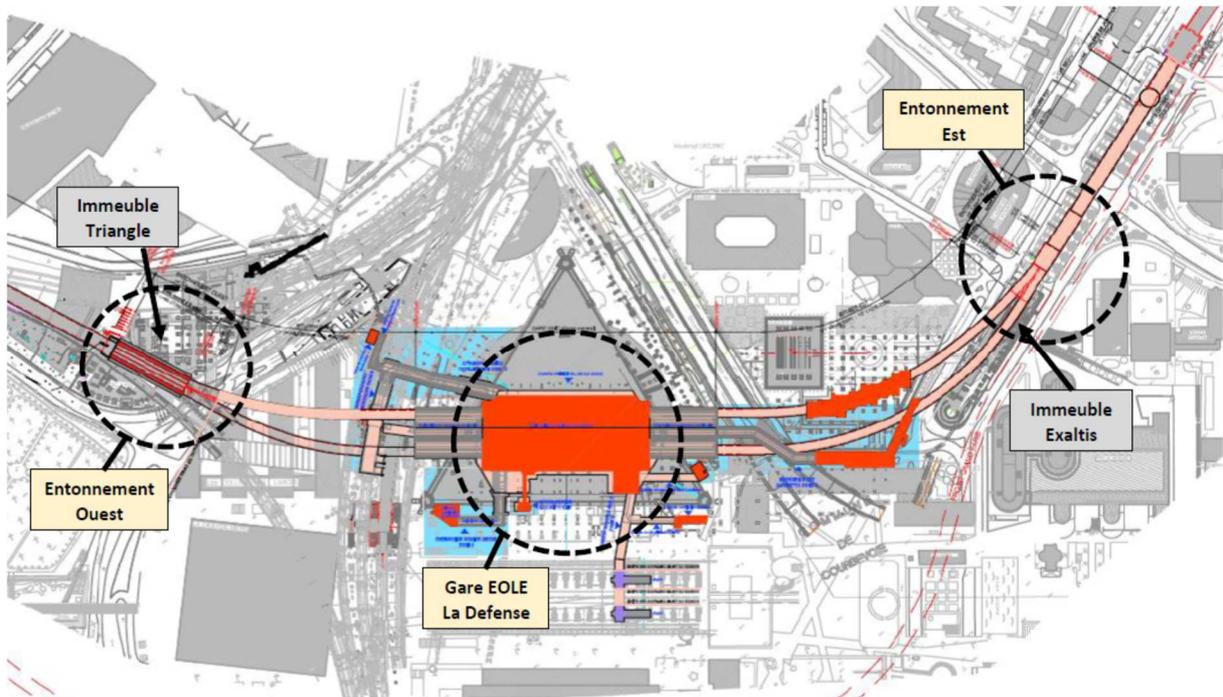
Vue d'ensemble du projet EOLE – La Défense
